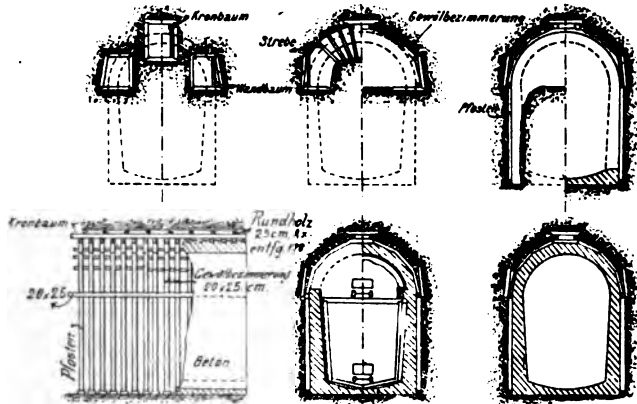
Baustadien des Kicking Horse River-Tunnels.
